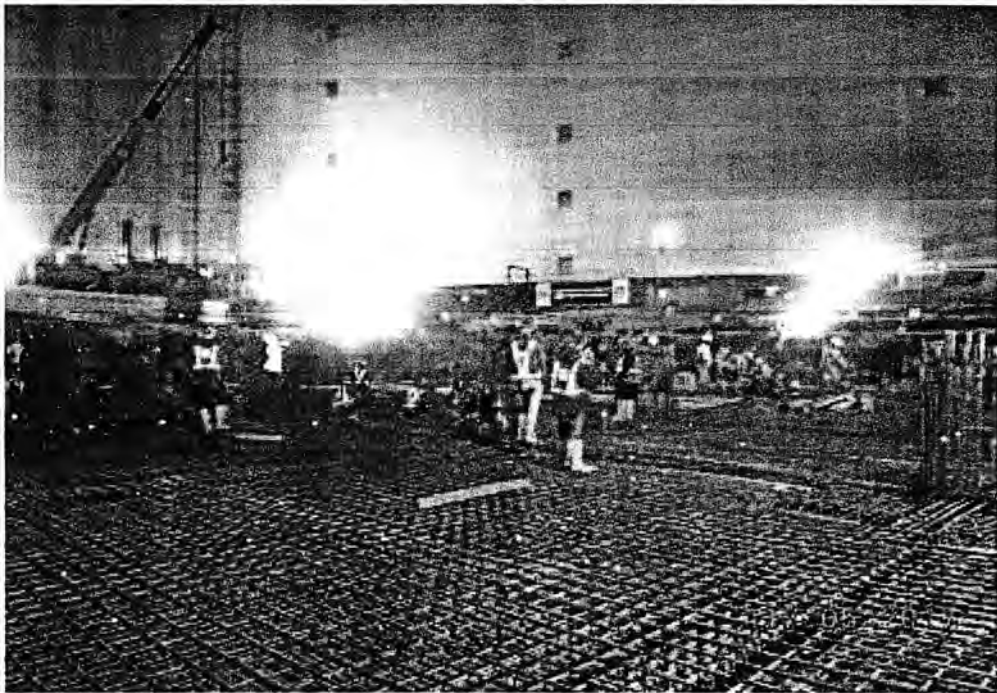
Pemasangan Bekisting Balok dan Plat Lantai
